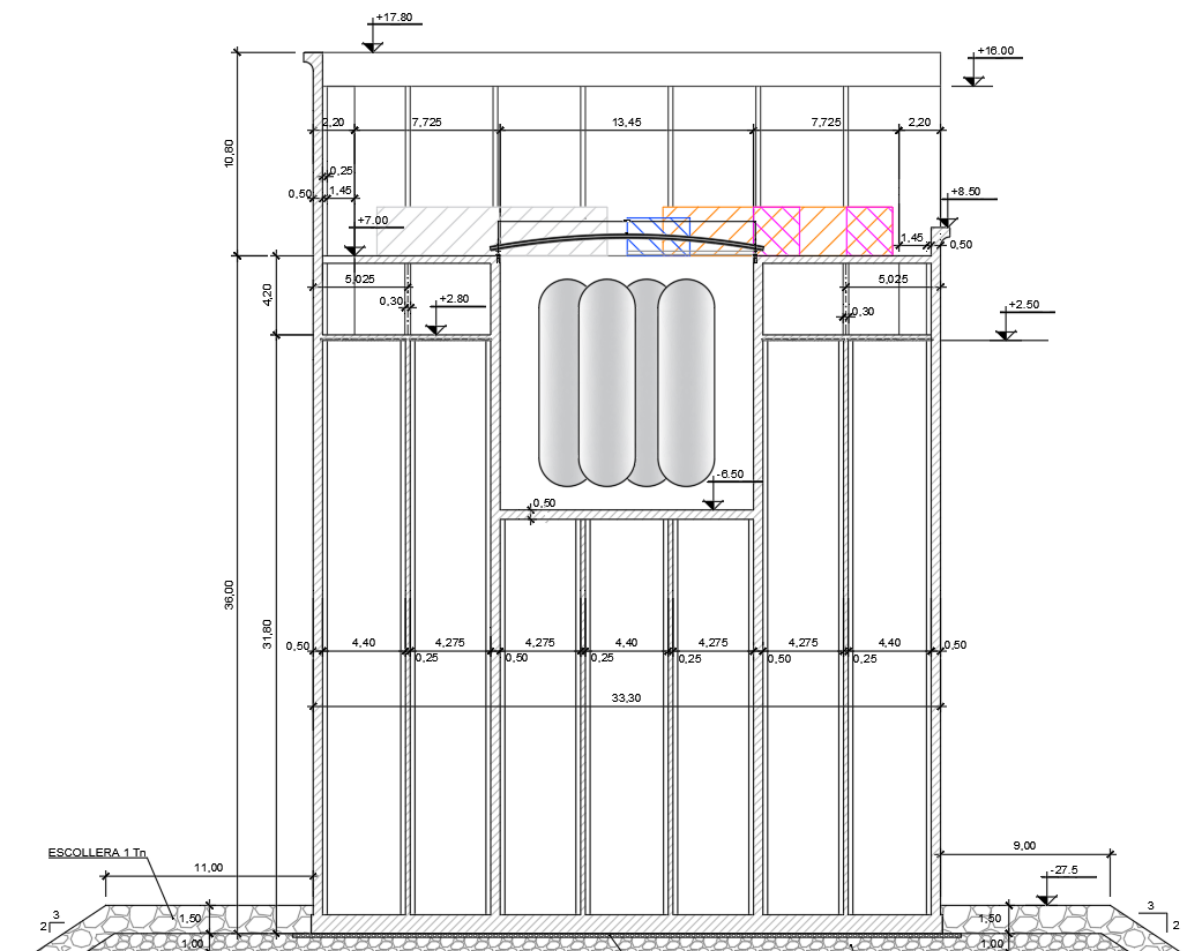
Sección transversal del GBS incluyendo la cubierta.
